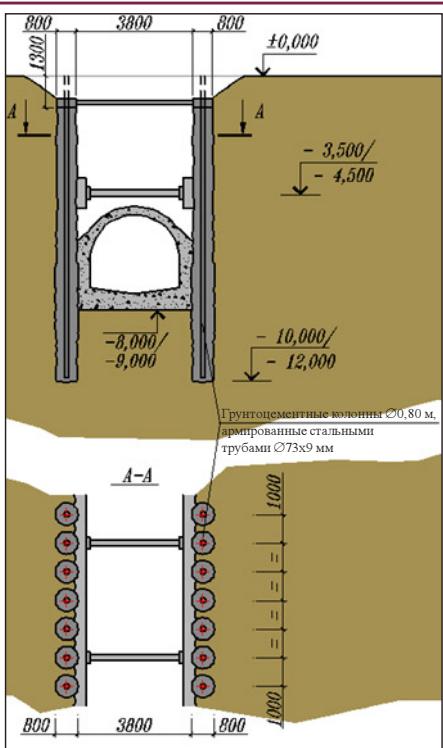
Ограждение котлована из грунтоцементных свай-колонн на строительстве коллектора открытым способом в Милане в коммуне «San Giovanni». Принципиальное решение.
